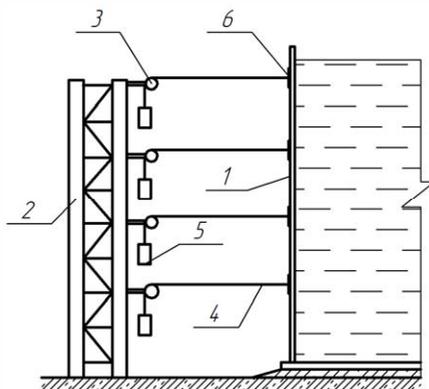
Установка прогибомеров для измерения горизонтальных перемещений стенки резервуара: 1 – стенка резервуара; 2 – временная опора; 3 – прогибомеры; 4 – рабочая нить; 5 – противовес; 6 – элемент крепления
